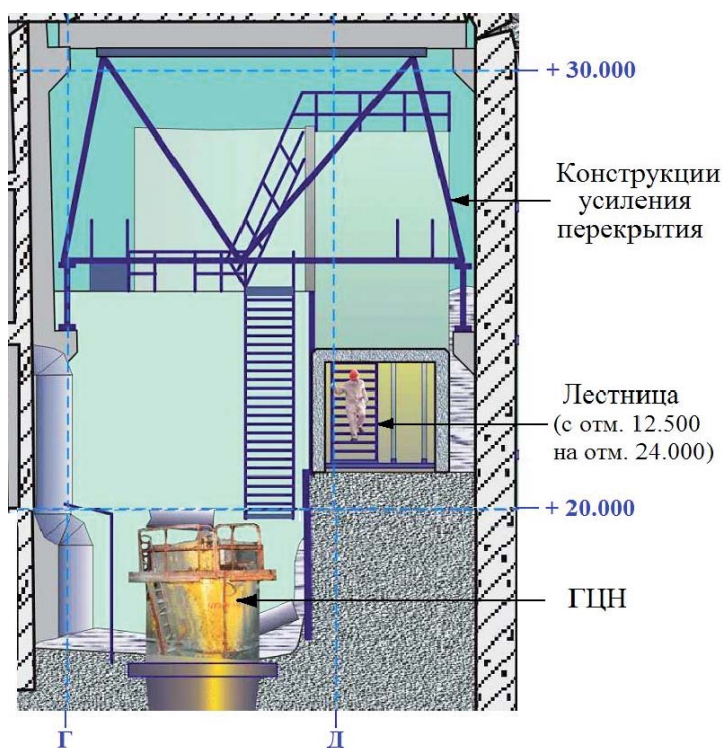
Схема усиления балок перекрытия в зале южных ГЦН (разрез по оси 46)
